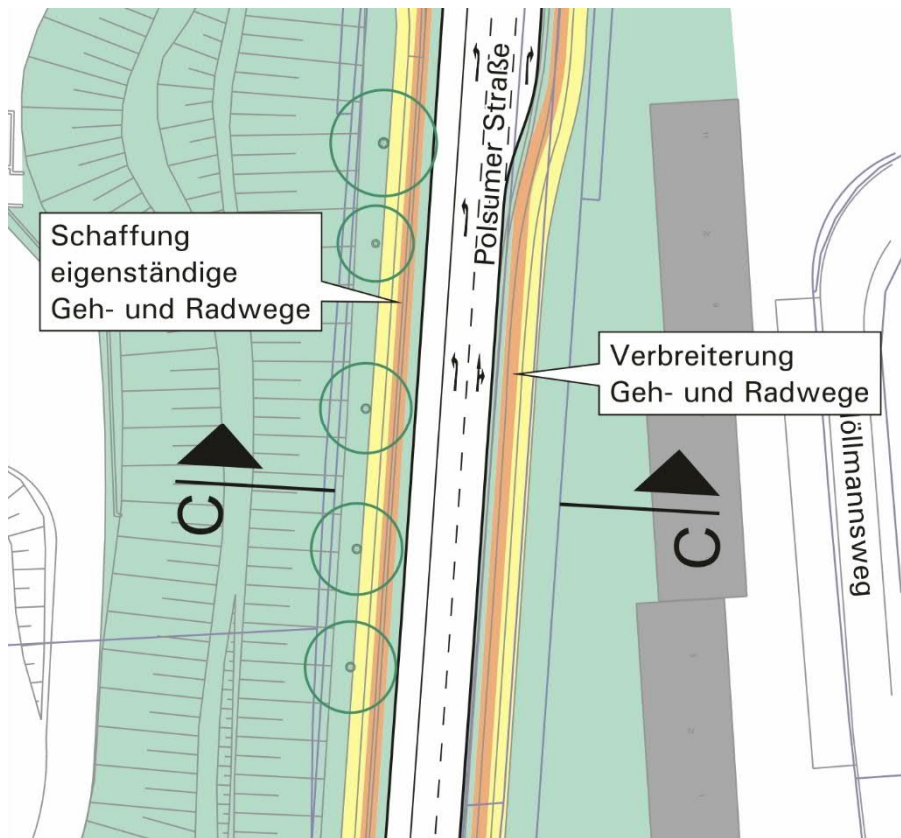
Lageplanausschnitt Außerorts – Variante 1 reduzierte Fahrbahnbreite
